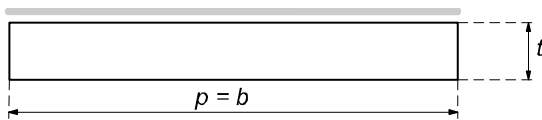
Exemple pour une section (schématisée) de lame de plancher sans rainure ni crête (profil à chants plats).
